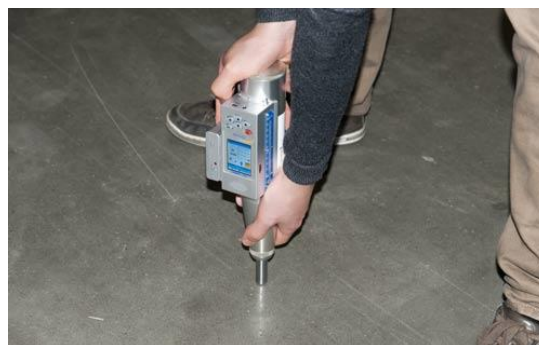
Prueba de Esclerómetro sobre losa maciza de concreto. (PCE Instruments, 2019)
